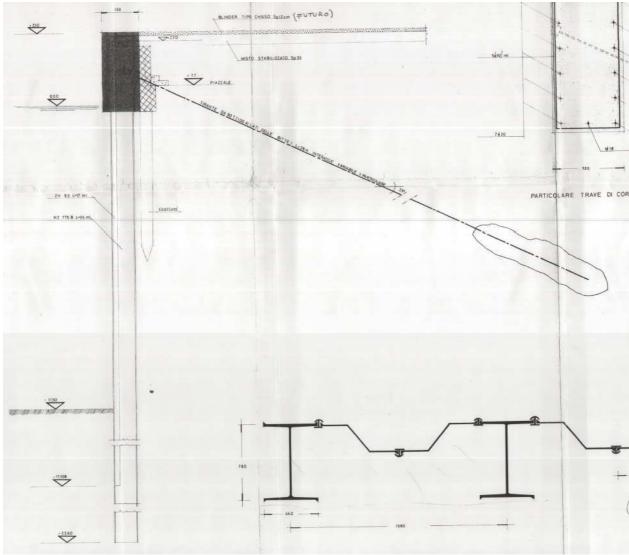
Sezione tipo del banchinamento (dal progetto del 1988)
